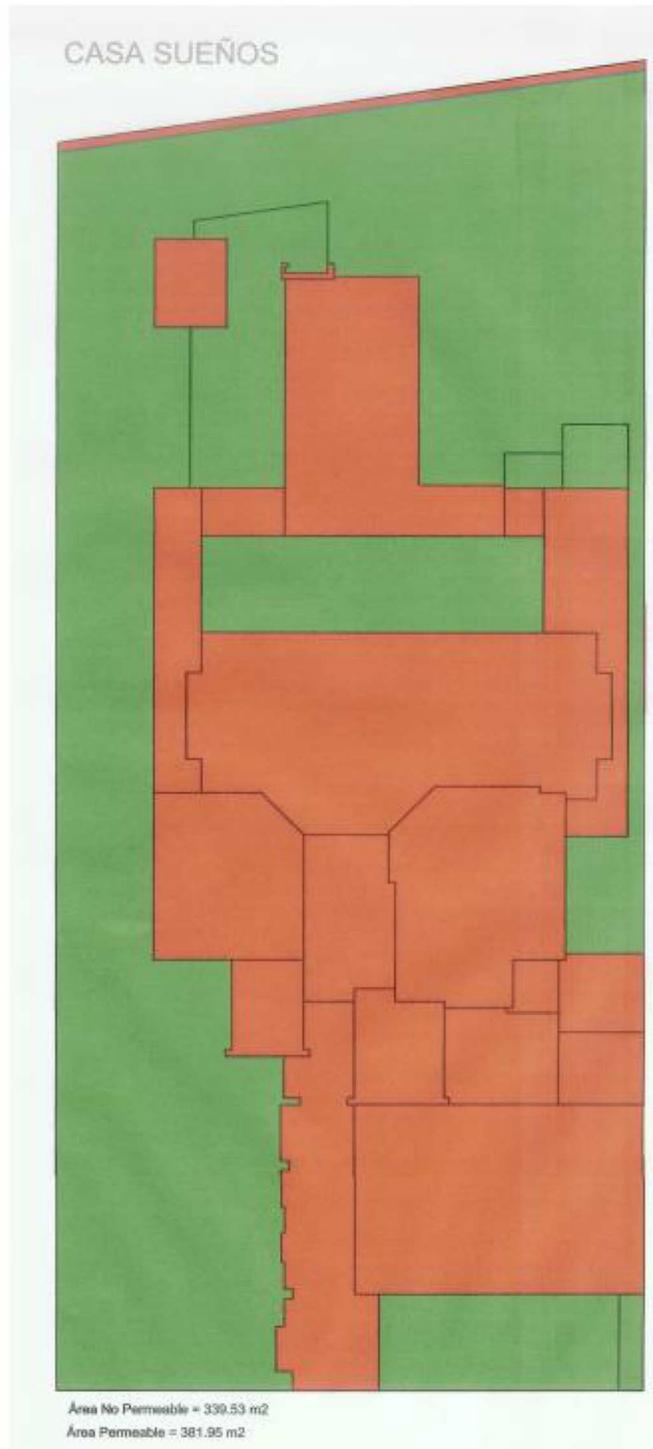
Plano de desplante de la planta baja del proyecto. Áreas rojas muestran el total construido o área no permeable (339.53 m²) mientras que las áreas verdes muestran las áreas permeables y verdes del proyecto (381.95 m²).
